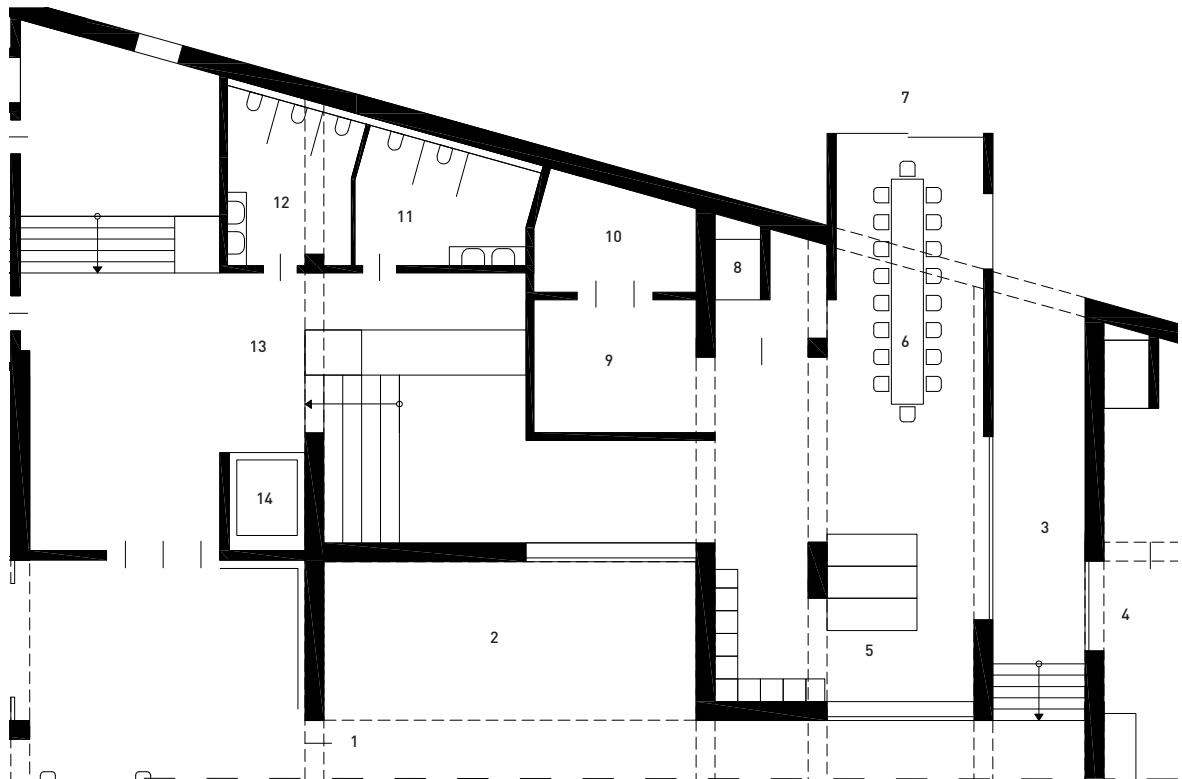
Grundriss Forschungsbereich Labor +0,00m M1:200
